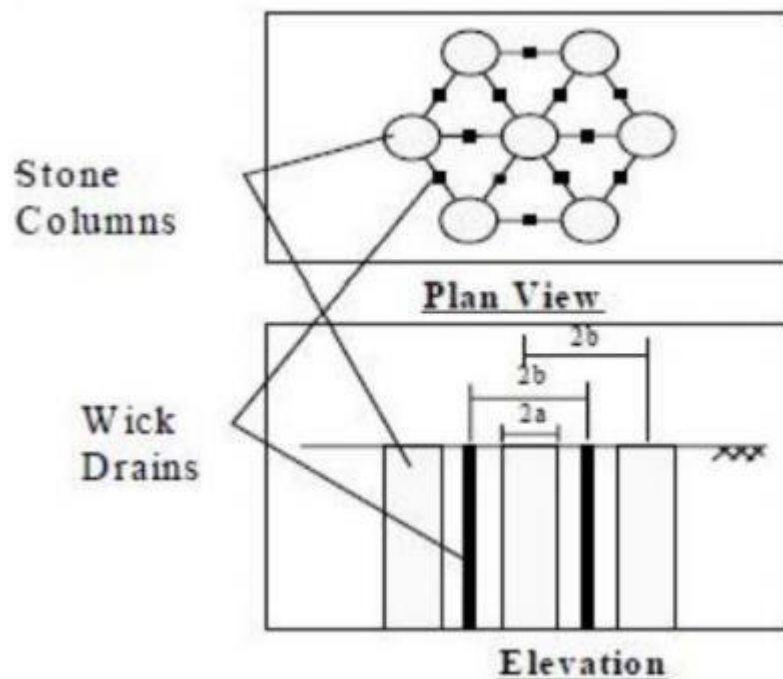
Mechas drenantes aplicadas en sistemas de columnas de grava.
